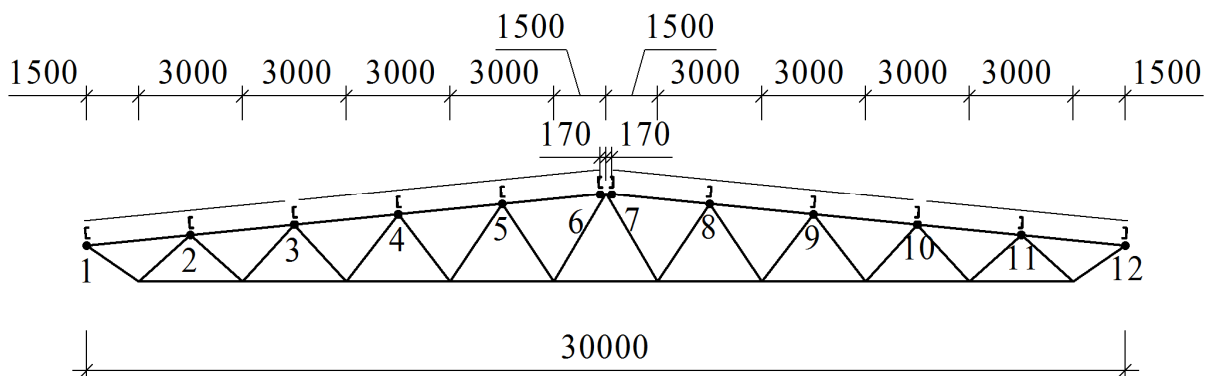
Нумерация узлов фермы, ширина грузовой площади.
